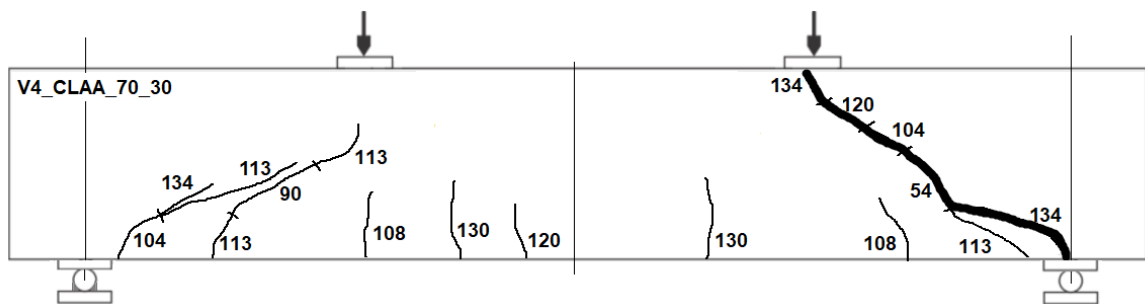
Esquema de fissuração da Viga 4_CLAA_70_30.
